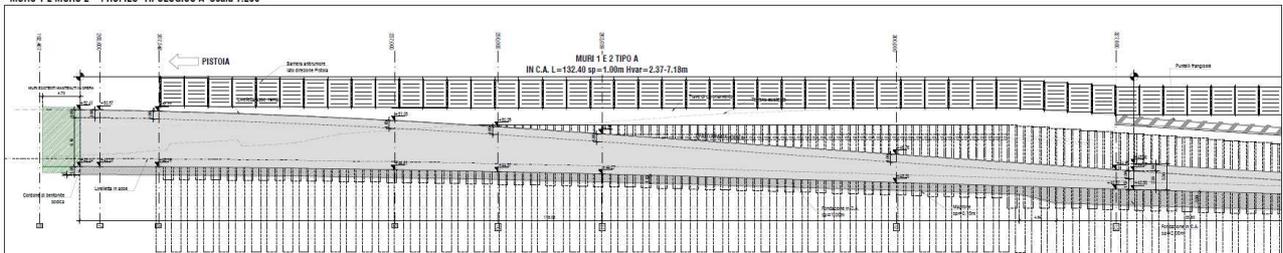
Stralcio sviluppata muri rampe di svicolo
